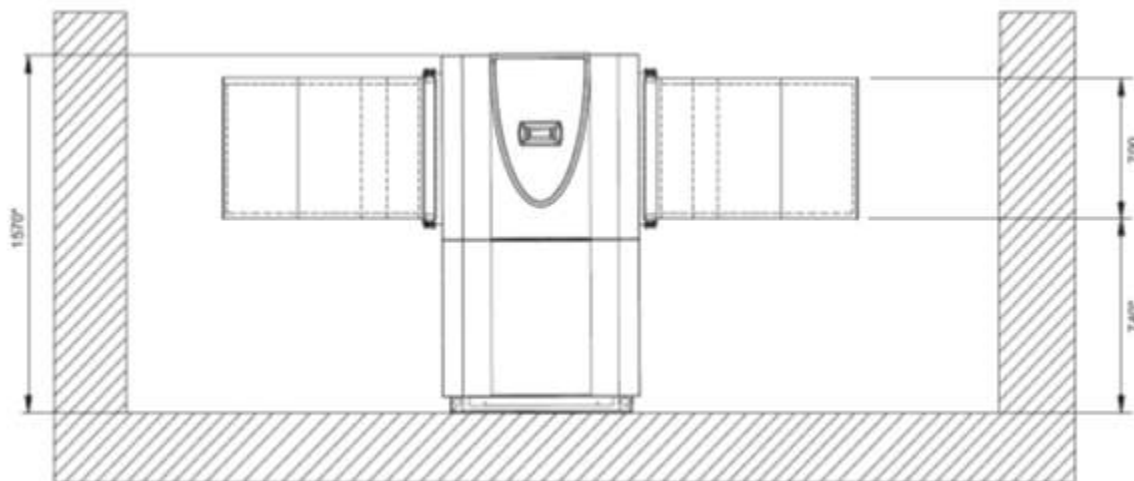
Vue de face - LI 16TES, LI 20TES (Installation murale avec conduit d'air côté admission et échappement)
